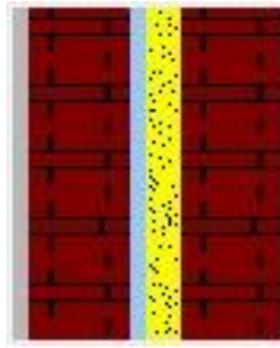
Cerramiento fachada norte, noreste y sureste.
